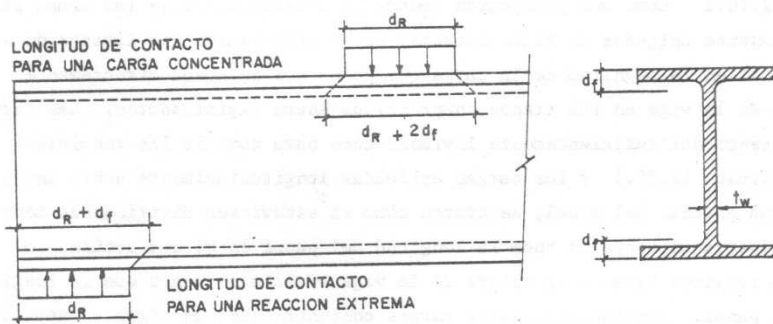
LONGITUDES PARA VERIFICAR EL APLASTAMIENTO LOCAL DEL ALMA EN VIGAS SIN RIGIDIZADORES TRANSVERSALES DE SOPORTE
